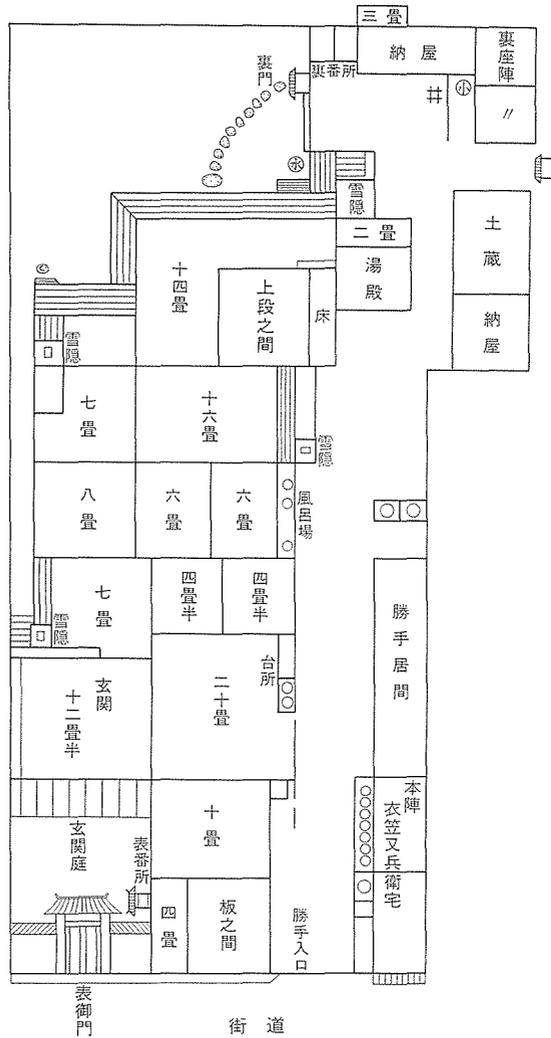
兵庫宿本陣井筒屋(衣笠又兵衛)平面図
